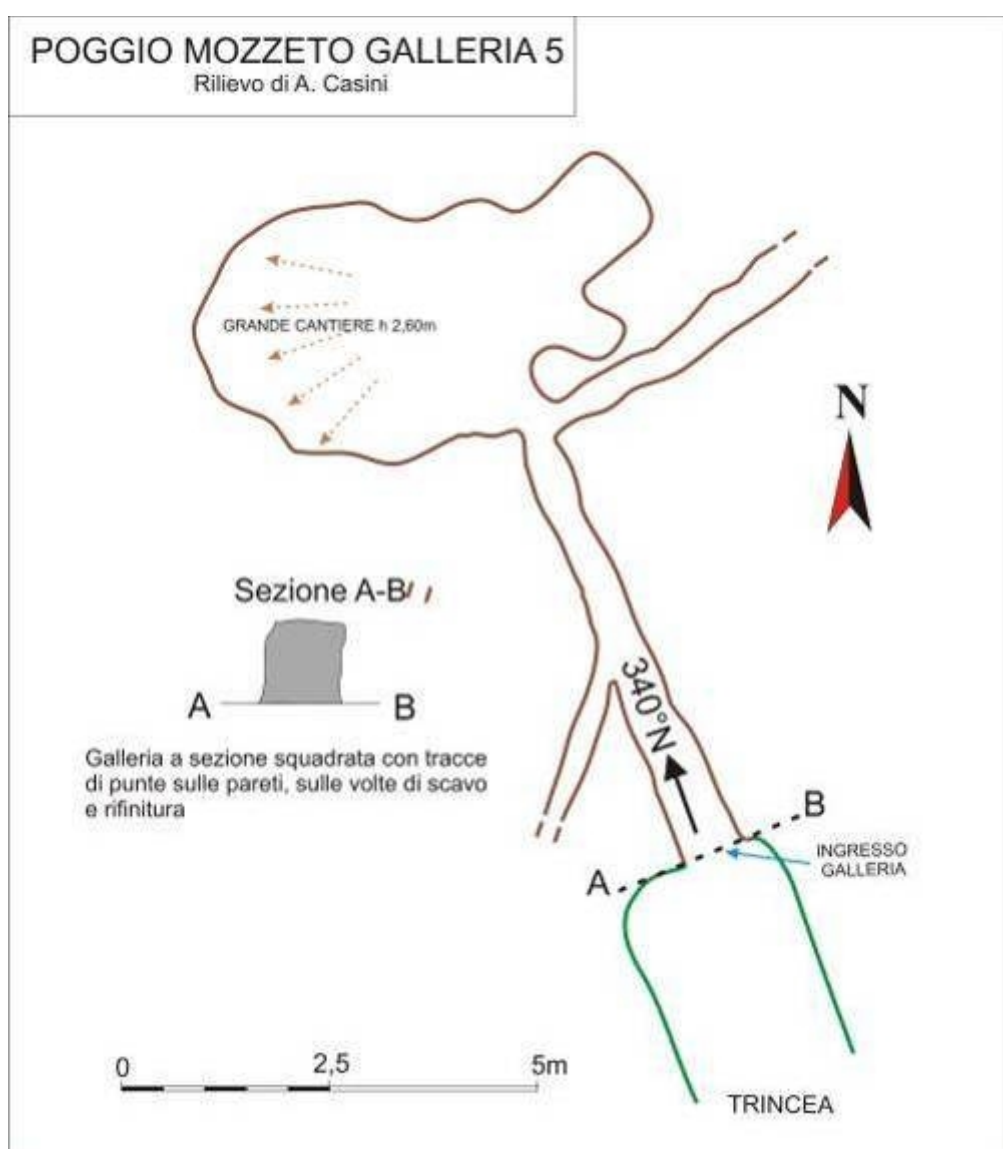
Sviluppo planimetrico speditivo della Galleria n°5
